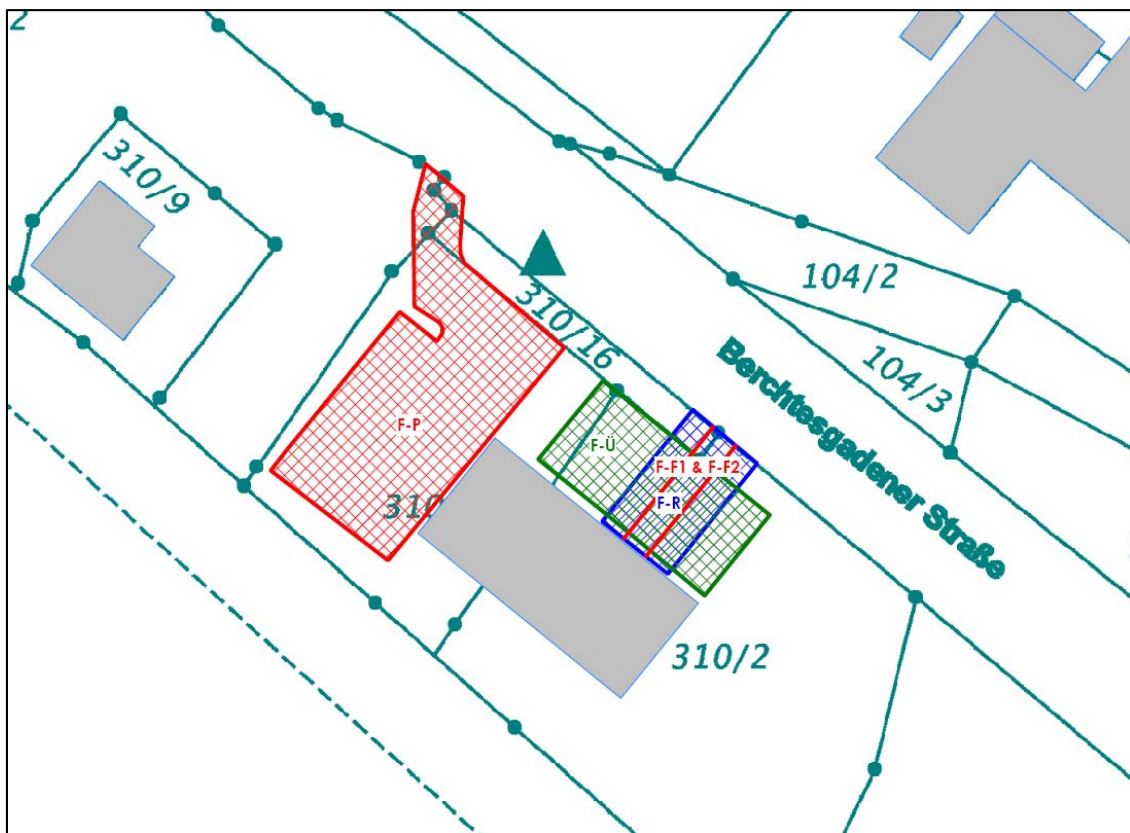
Lageplan mit Darstellung der Schallquellen
